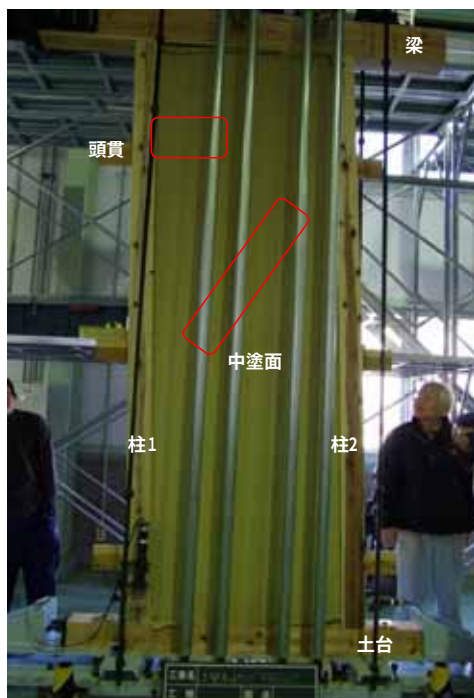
中塗り側 1/25rad セン断ひび割れ、頭貫に沿ったひび割れ
